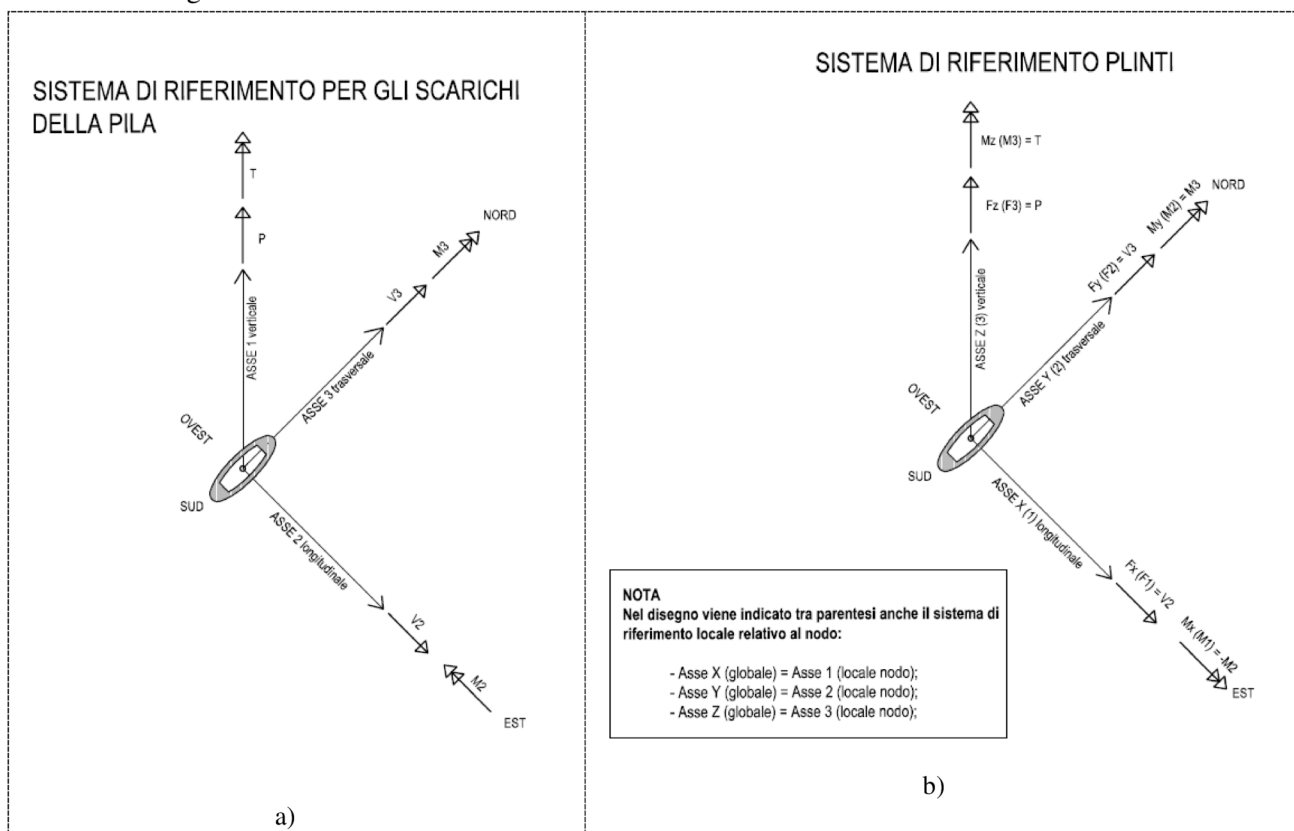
Convenzione scarichi in funzione dei SdR dei modelli di calcolo f.e.m.: a) scarichi trasmessi dalla base della pila a estradosso plinto di fondazione; b) scarichi applicati al plinto di fondazione in corrispondenza del nodo di base della pila.
